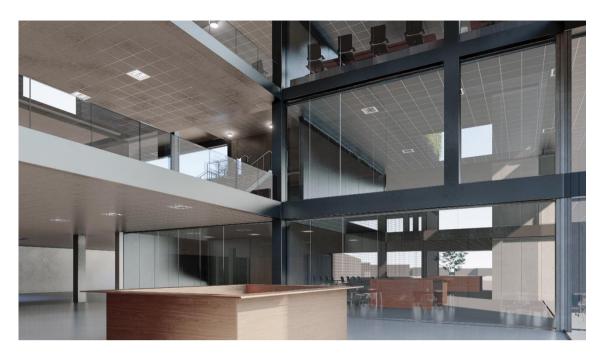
Vista interior hall de ingreso Fuente: elaboración propia
